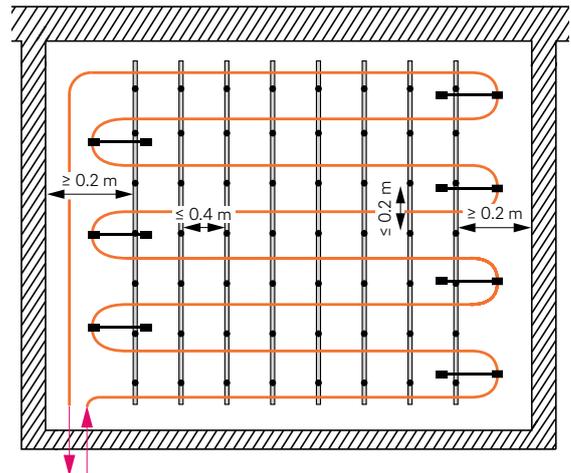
Einfachmäanderförmige Ausführung, VA 10 cm (Draufsicht Bodenfläche)
